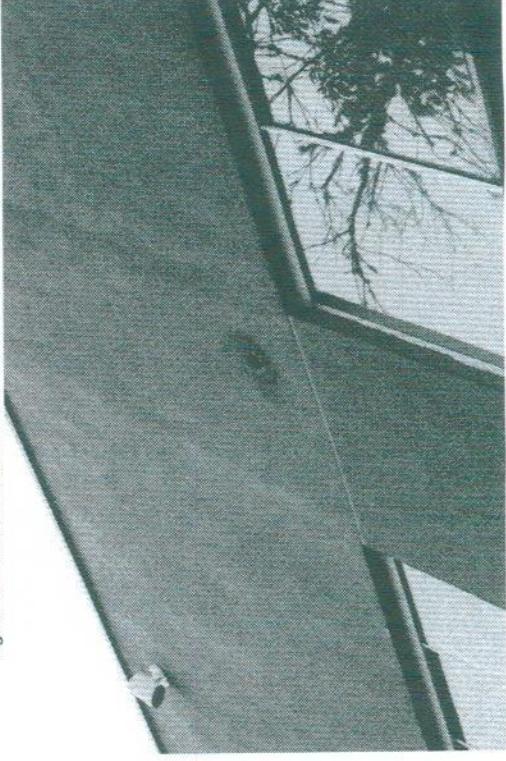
Presença de fissuras, mudança de tonalidade e biodeterioração da pintura (este)
